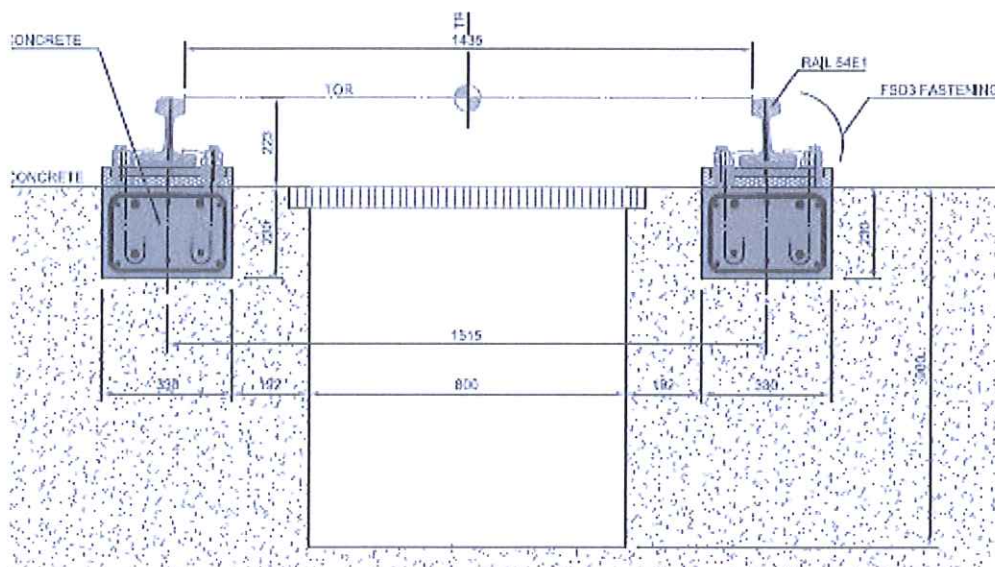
Secțiune transversală tipică pentru calea de rulare de la stația de spălare
